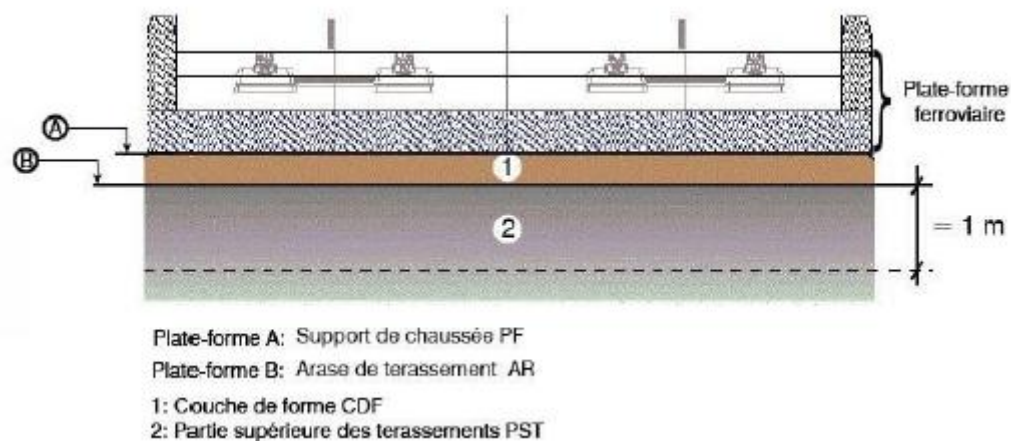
Coupe transversal de la plateforme ferroviaire représente la couche de forme. [2]
